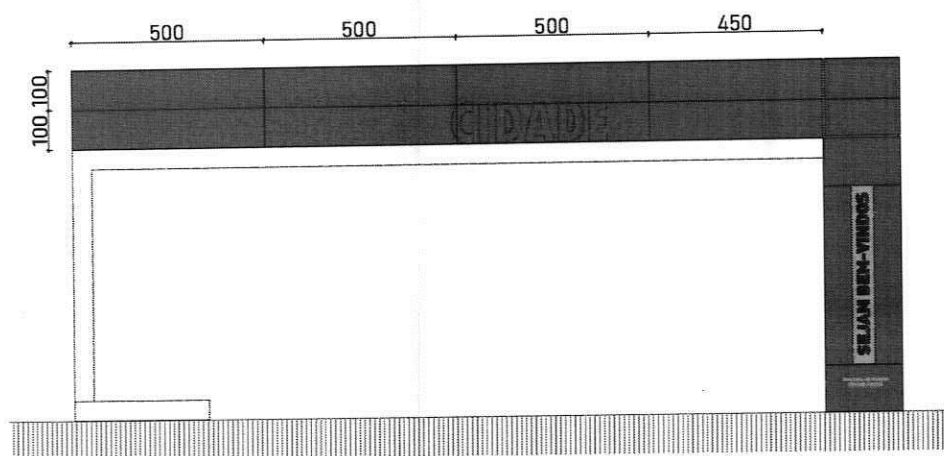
Desenho esquemático da paginação das placas ACM – parte frontal
